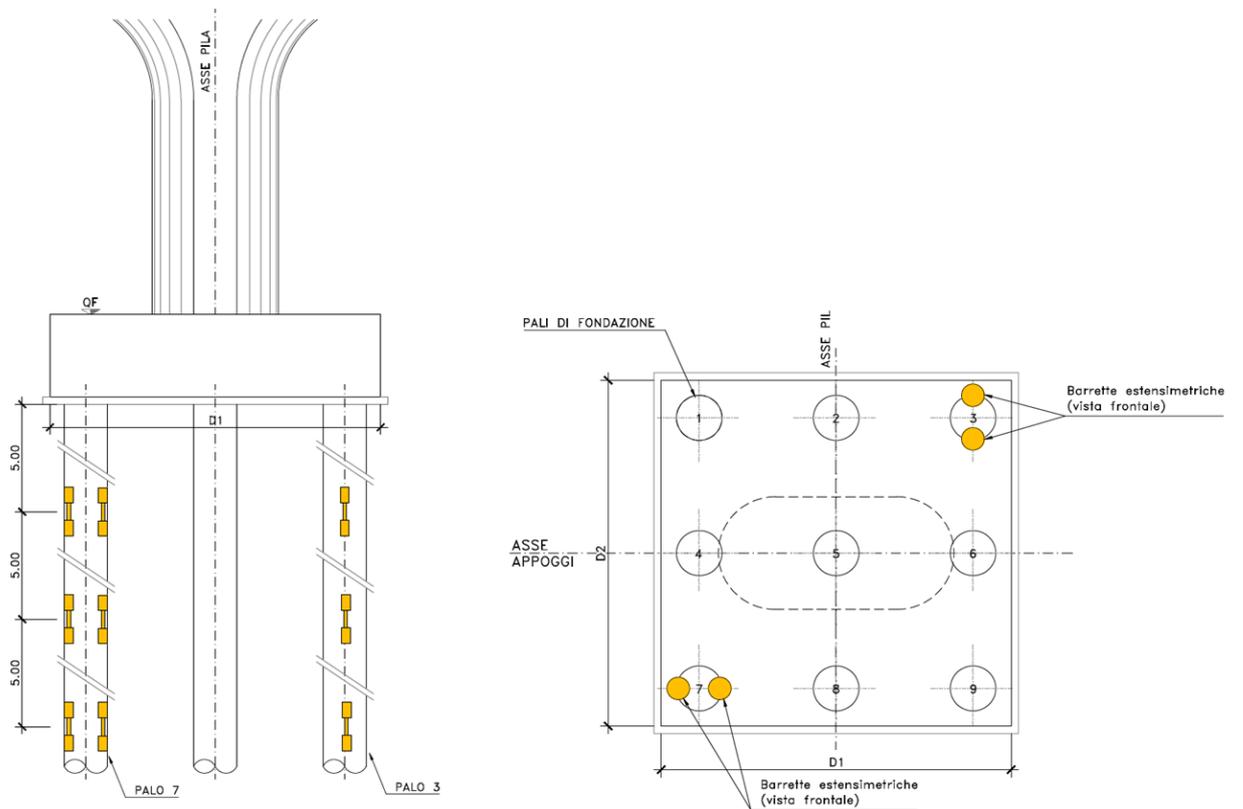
Sezione (sx) e pianta (dx) fondazione pila
